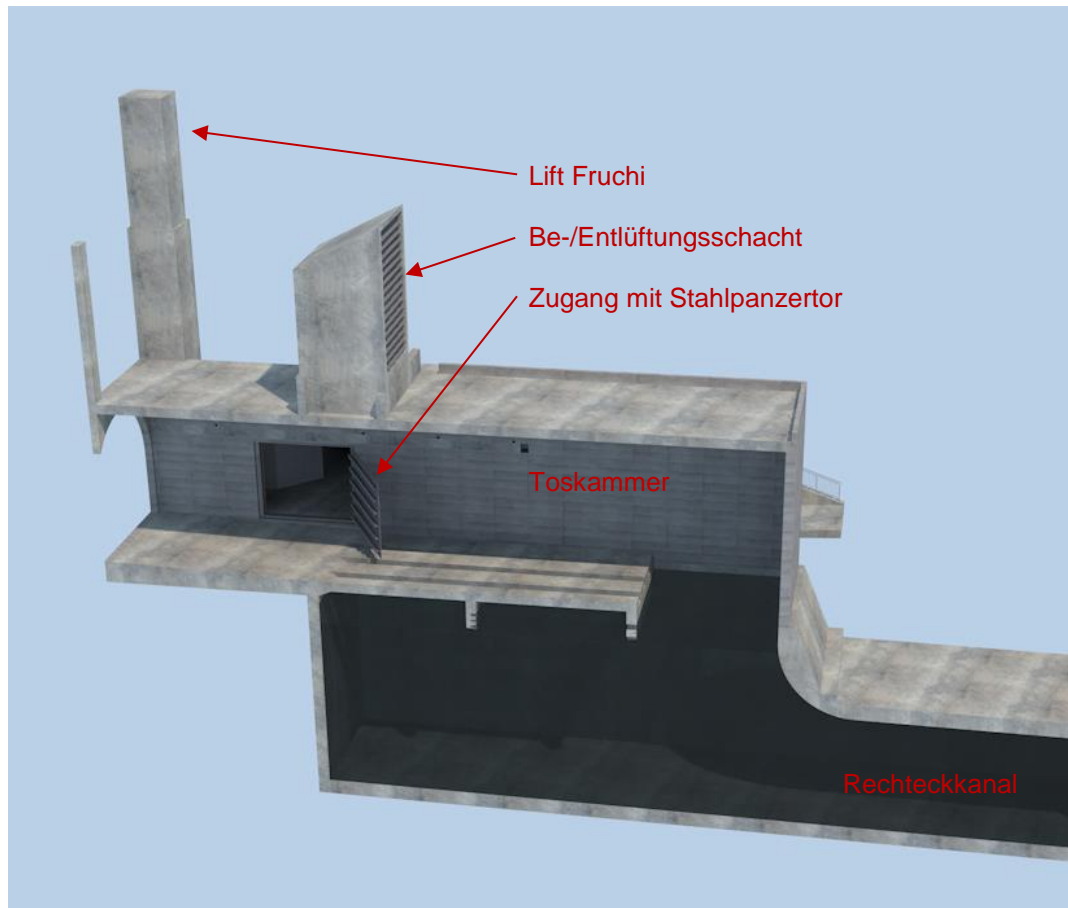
Toskammer mit Be-/Entlüftungsschacht und offenem Stahlpanzertor
